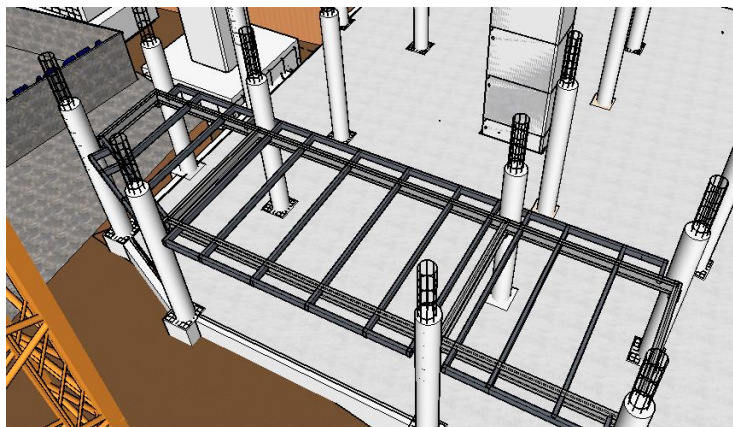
Render de colocación de vigas metálicas secundarias
